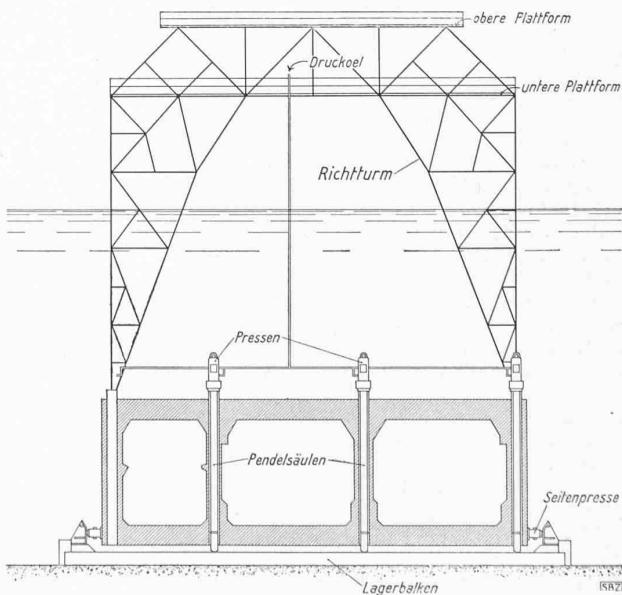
Schema der Auflagerung und Ausrichtung eines Tunnelstücks (äußerste Pendelsäule links nicht gezeichnet)
